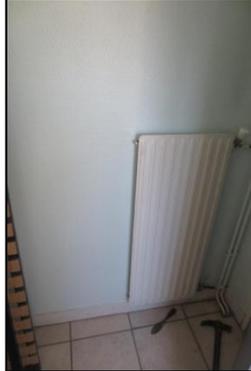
ECH-3 -1er-Salle de Bains_1er Murs Plâtre+Peinture+Toile de verre
